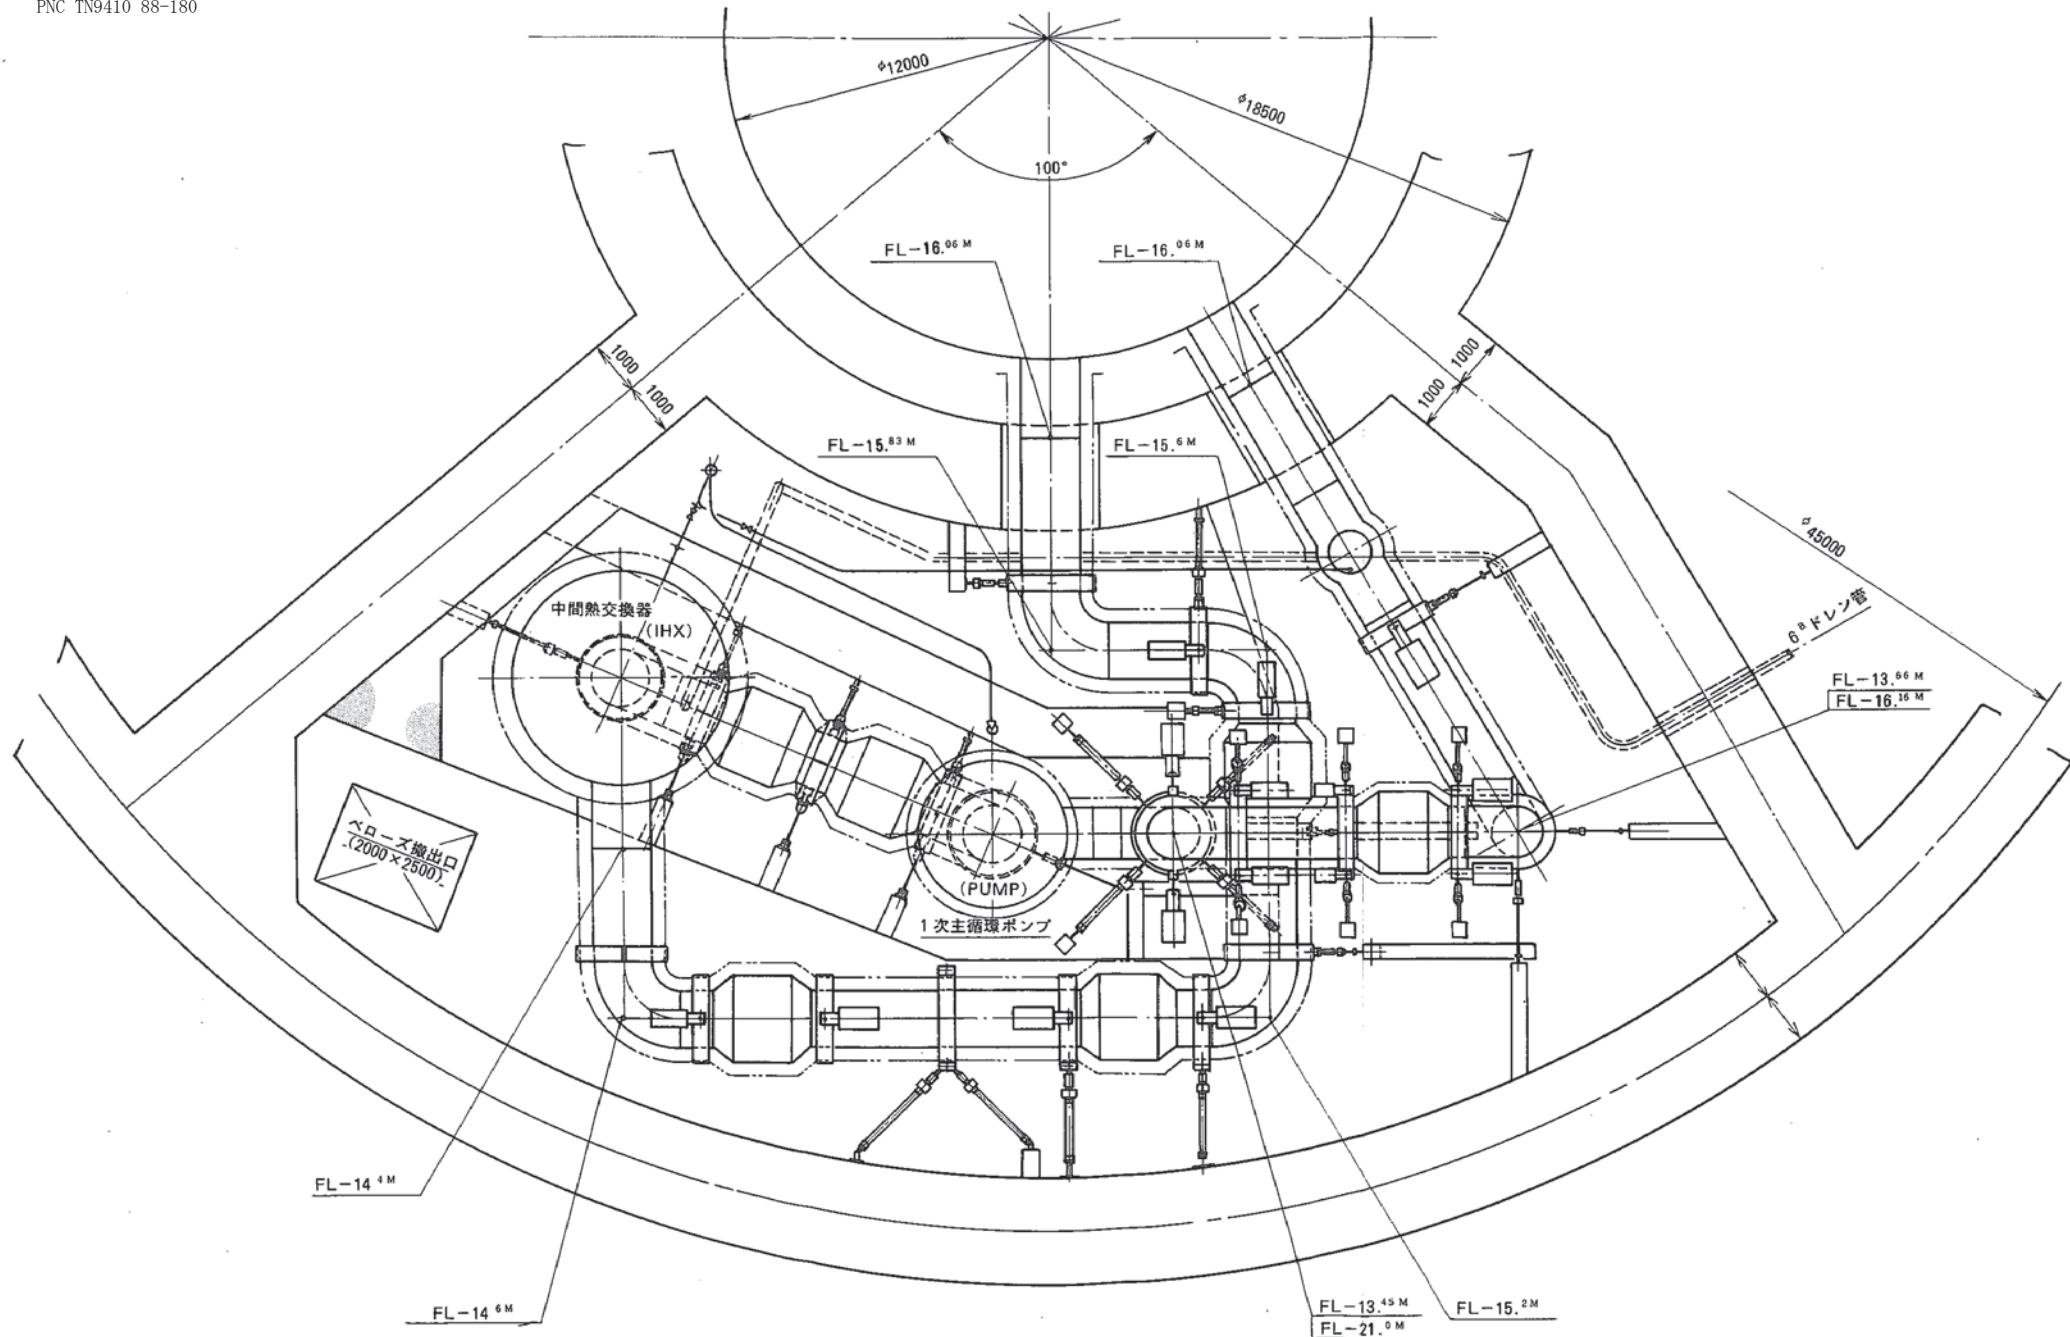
1次主冷却機器配管配置図（平面図）
